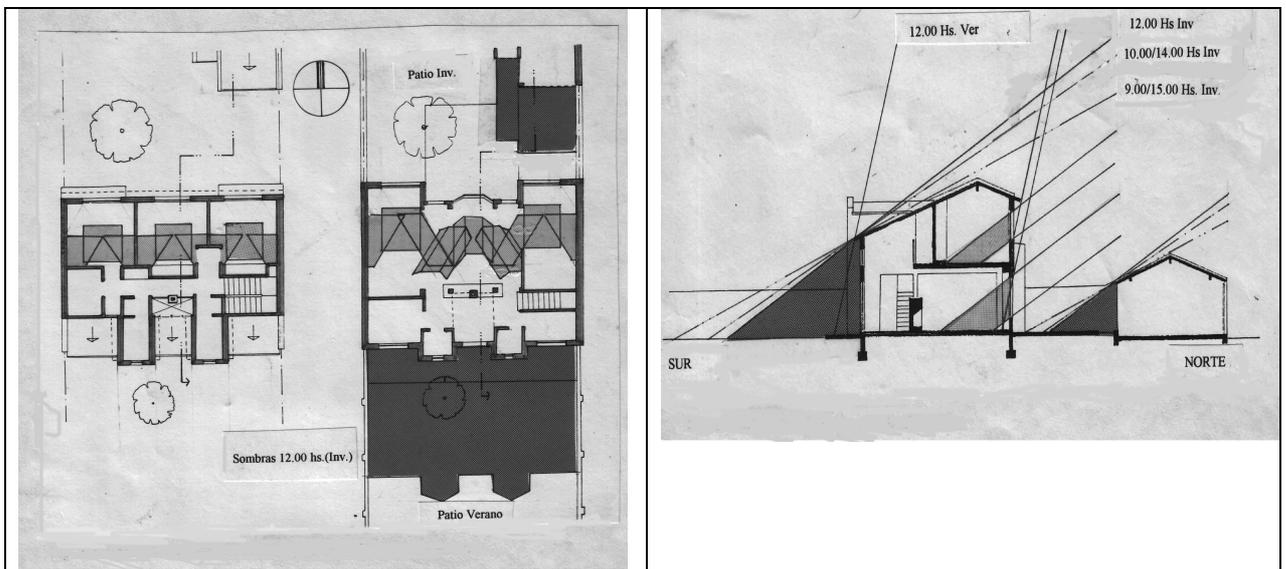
Esquema de plantas (alta y baja) y corte con sombras – Vivienda 1
